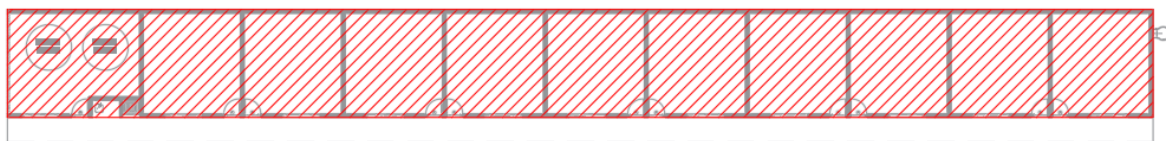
Áreas consideradas para o pavimento em contato com a fundação (Edícula)
